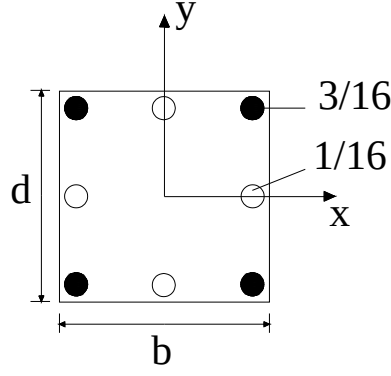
Dikdörtgen betonarme kesitlerde köşelerde ve kenar ortalarında sekiz eşit donatı yerleşimi.
